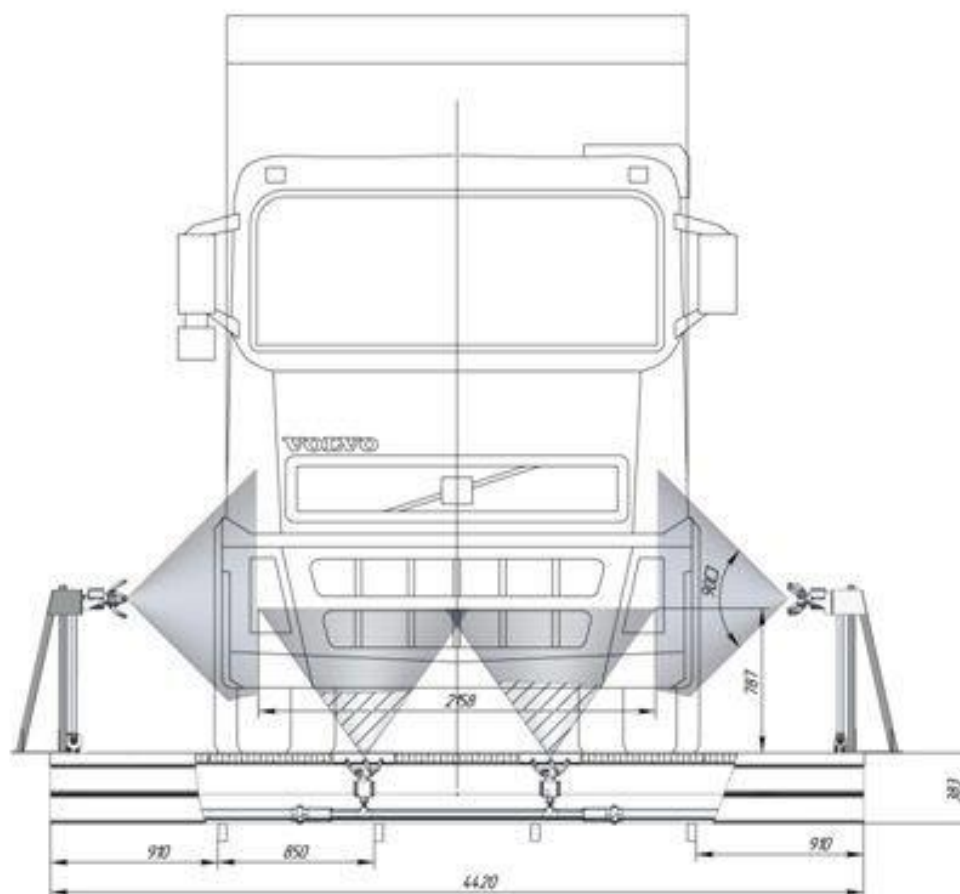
Установка для мойки колес грузового автомобиля,
